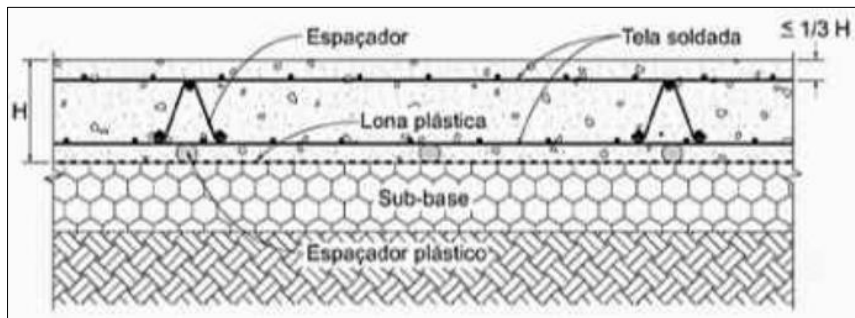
Detalhe de camadas e posicionamento de armaduras de piso industrial
